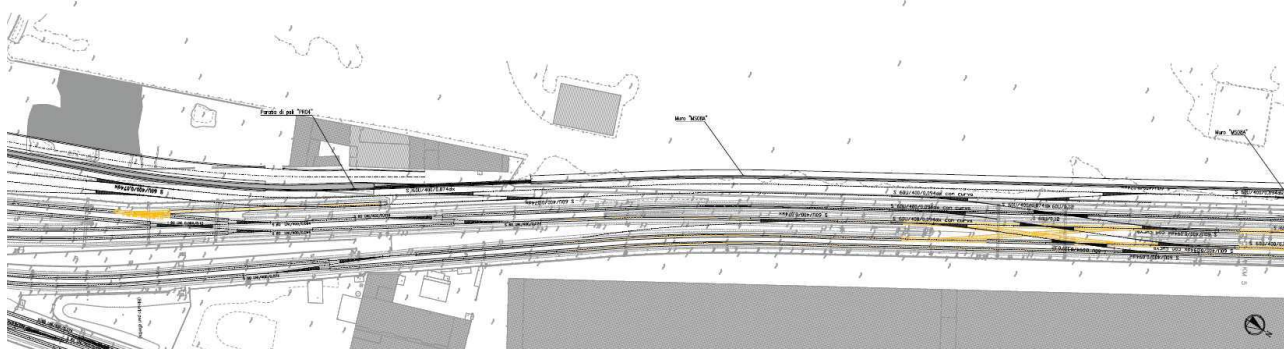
Planimetria di progetto (radice nord di Saronno)
